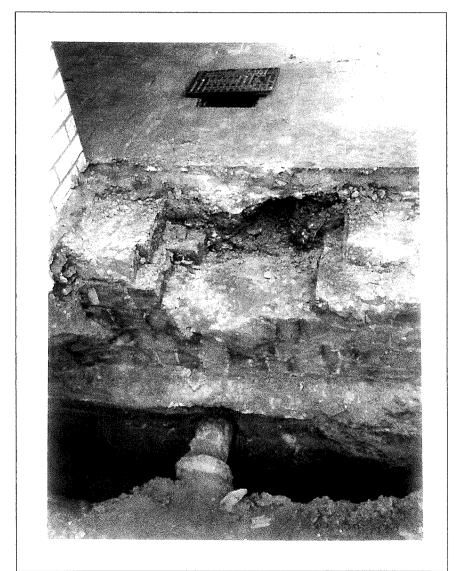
Einfahrt zur Waschhalle, Abscheider, verunreinigtes Fundament
